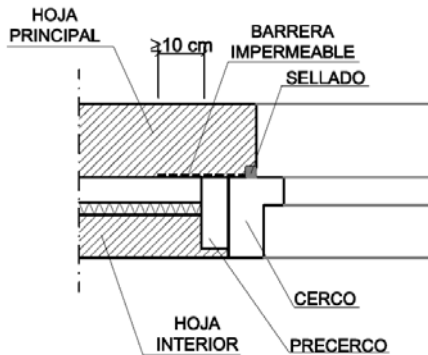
Ejemplo de encuentro de la fachada con la carpintería.
